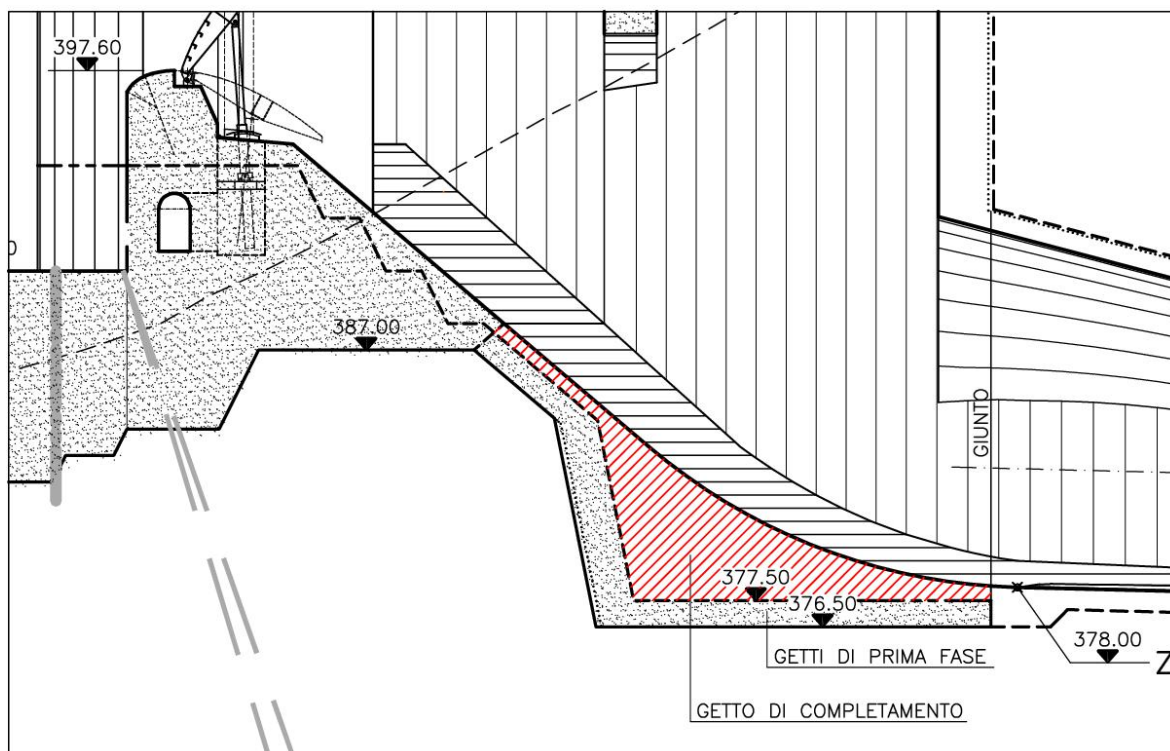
Profilo in asse con indicazione del getto di completamento di seconda fase
